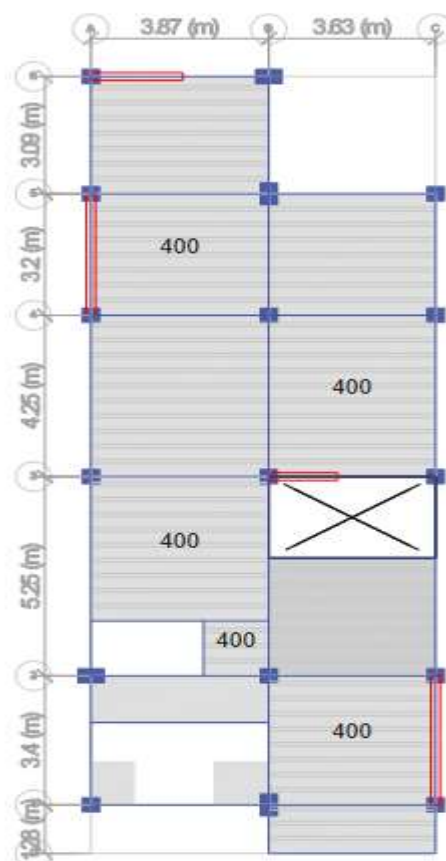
Vista de Planta Asignación de Carga viva live 01 al 4to piso
